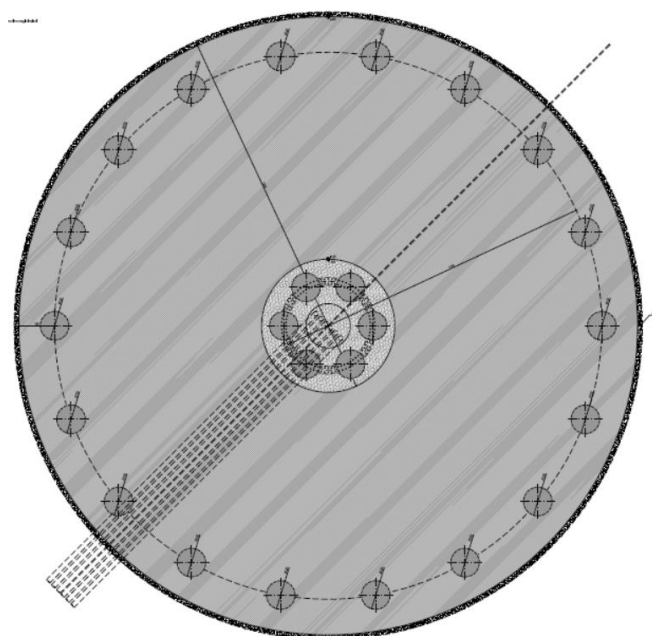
Planimetria schematica della distribuzione dei pali profondi da realizzare
